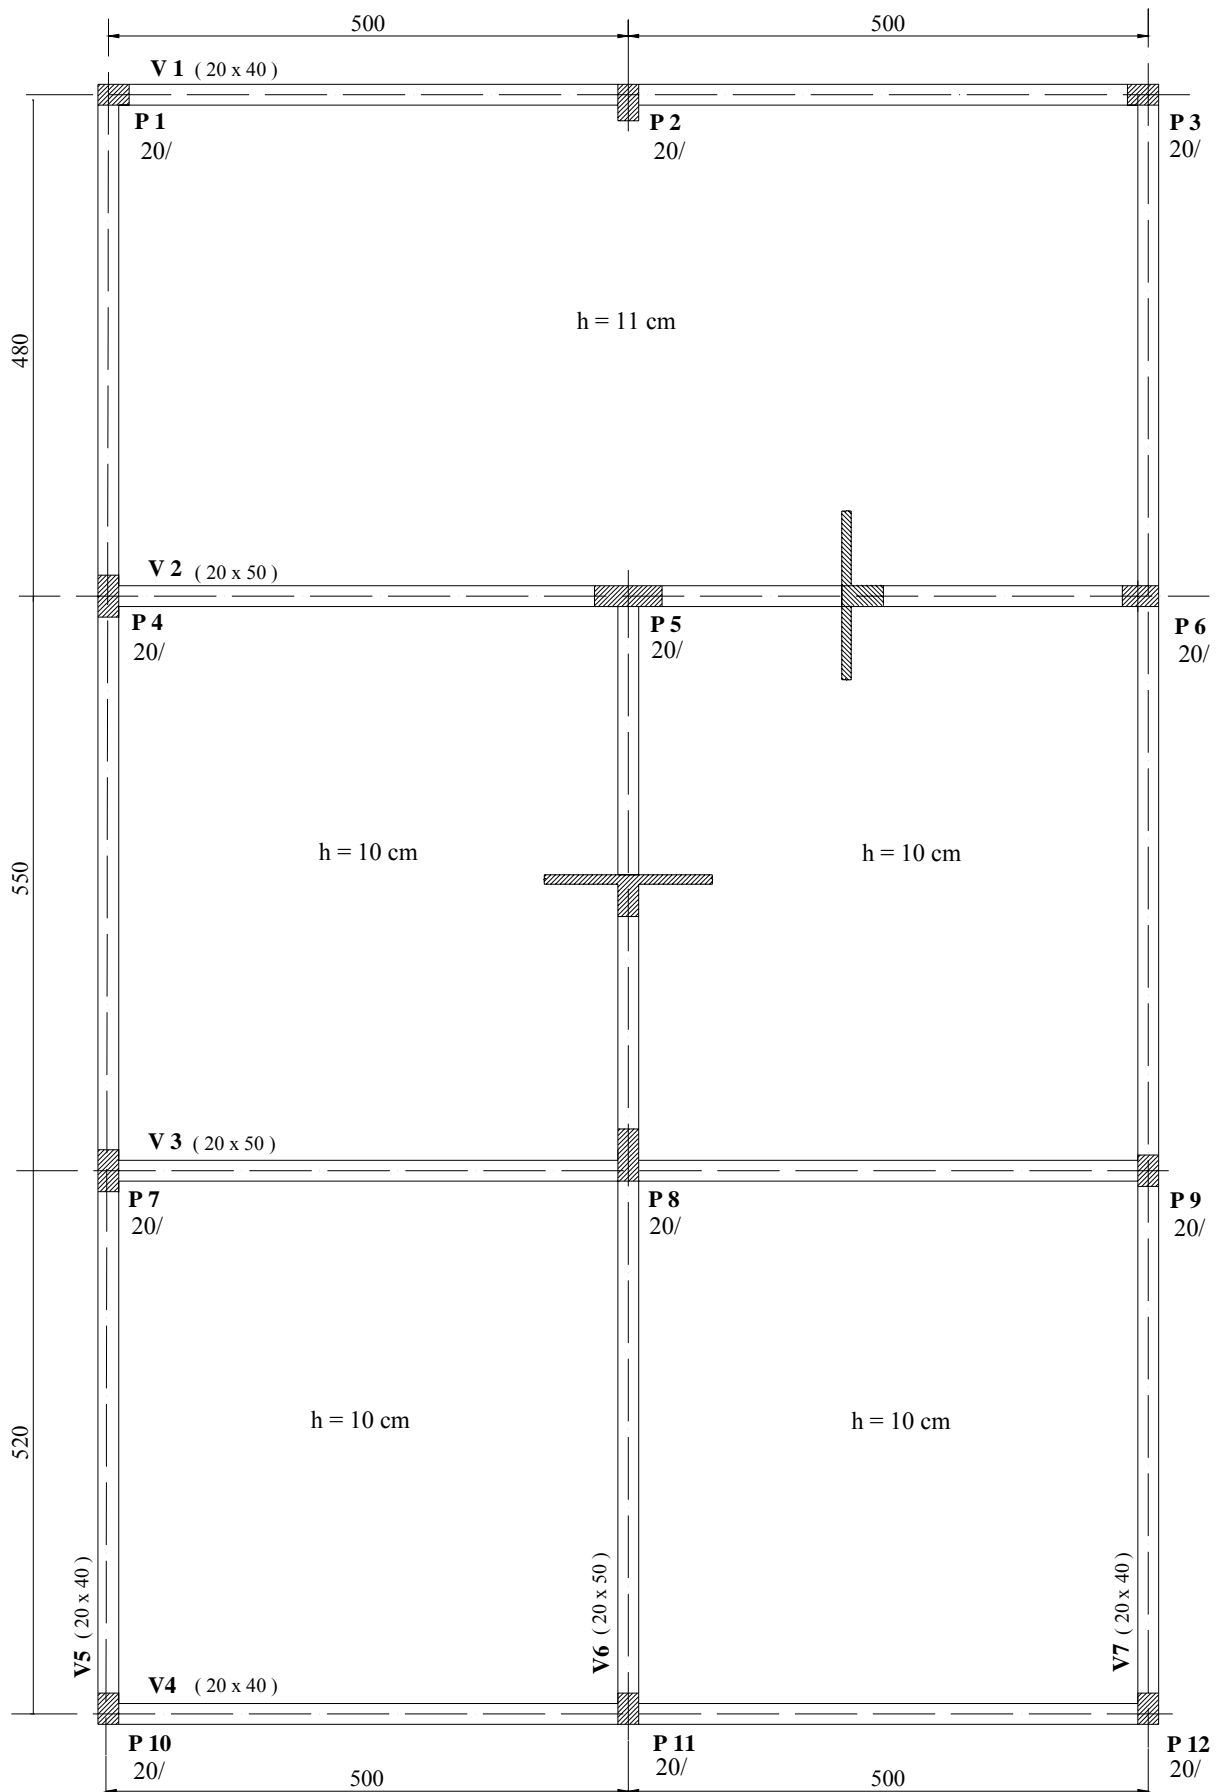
Planta de fôrma do pavimento tipo do edifício.
